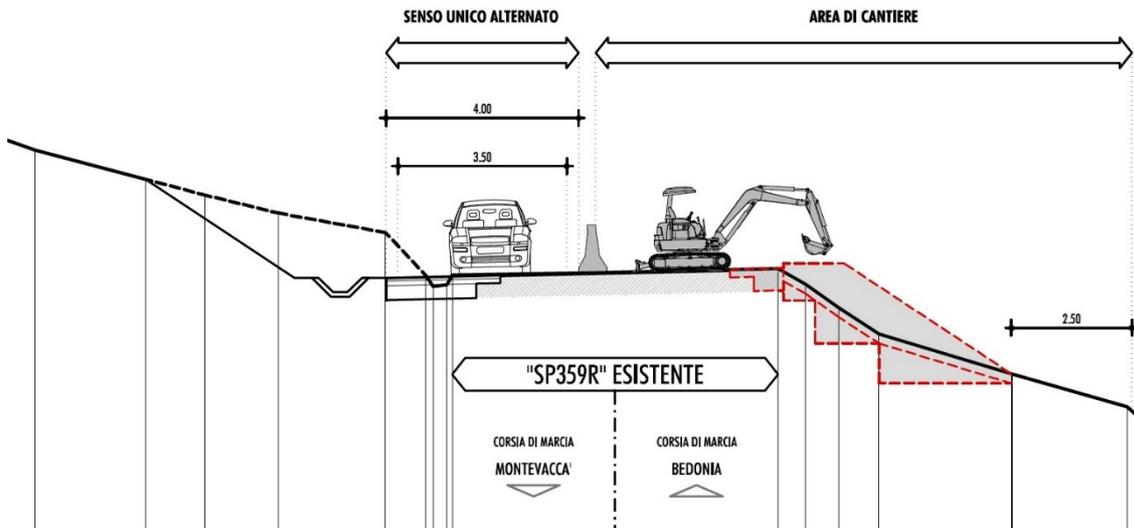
TRATTO 1, FASE 2: TRAFFICO SU CORSIA DI MONTE (ESTRATTO DALL'ELAB. PD.04.04)
